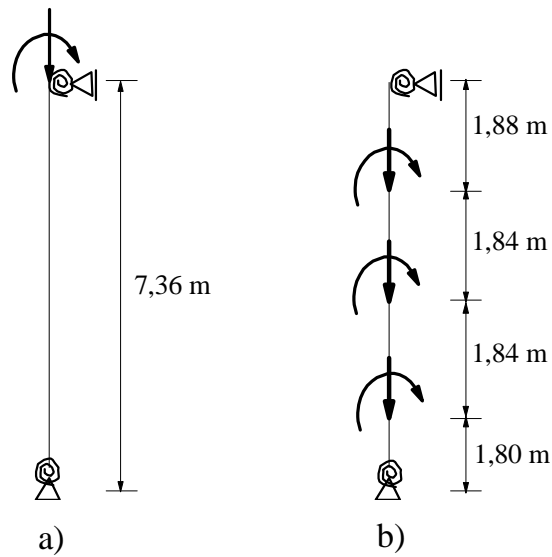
Configuração de carregamento das colunas: (a) Carregamento apenas na extremidade; (b) Configuração real de carregamento.
